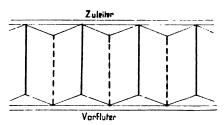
Rünftlicher Rückenbau; Lageplan.
